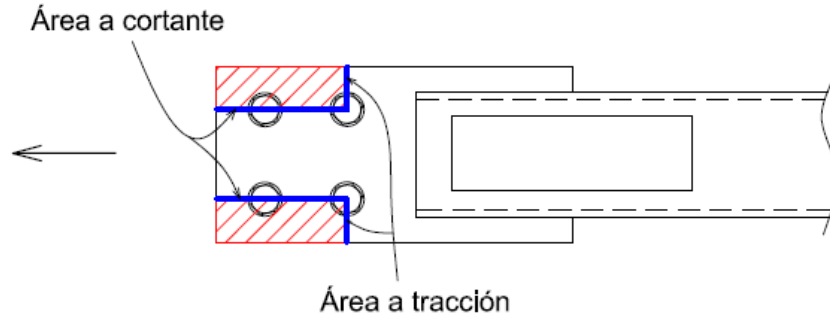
Bloque de corte en plancha PL1-forma en 2L
